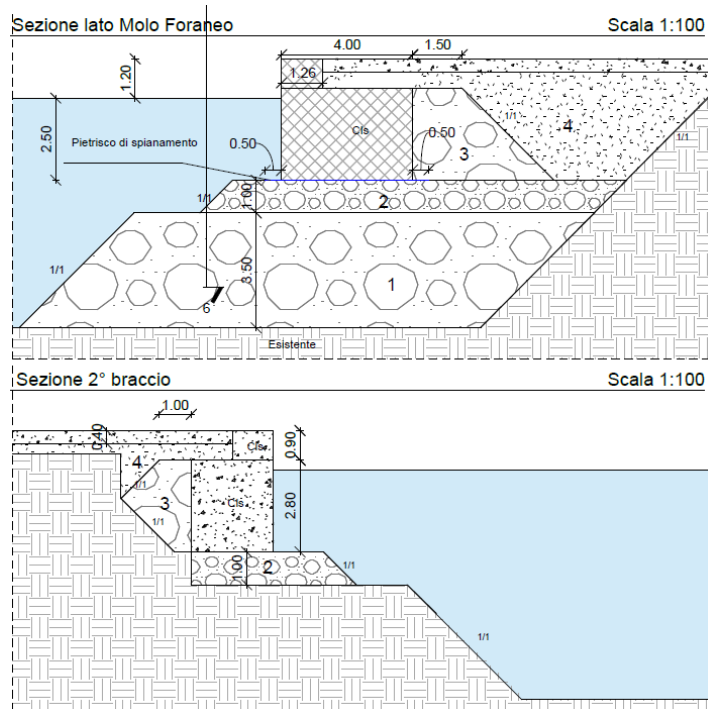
Particolare sezione di progetto lato Molo Foraneo e 2^a braccio
